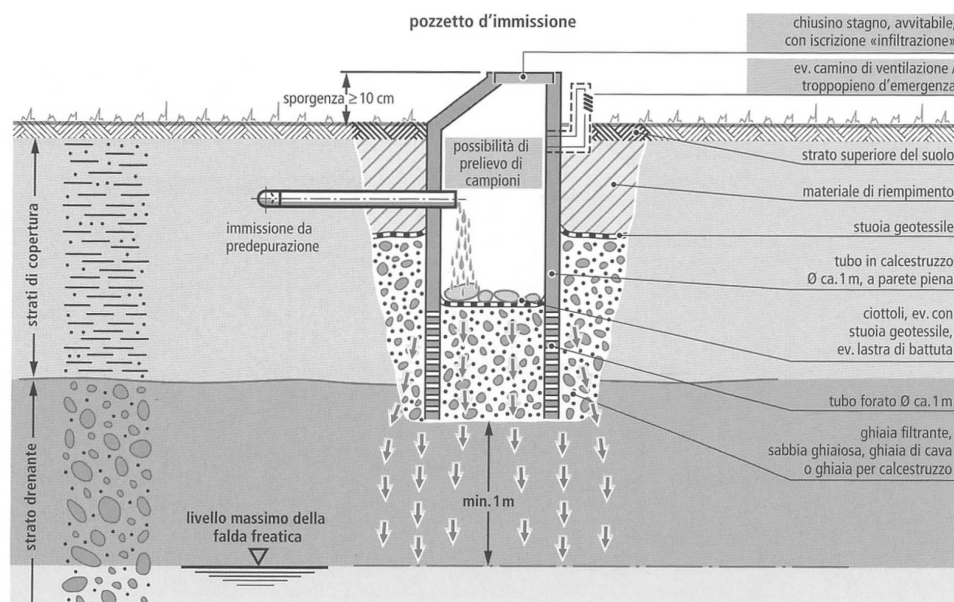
SEZIONE TIPO DI POSA POZZO DISPERDENTE
